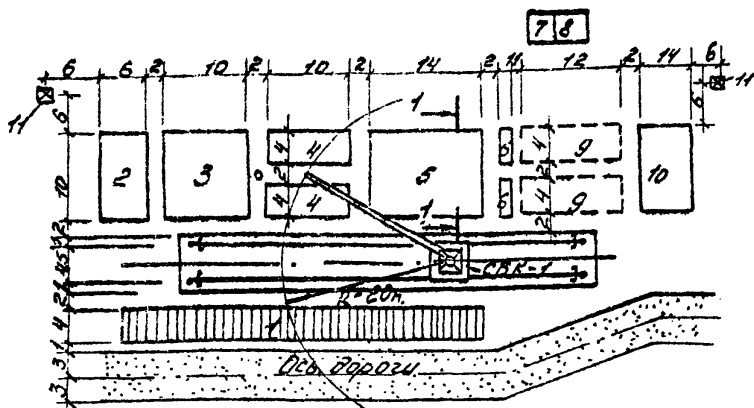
Схема сборно-комплектующей площадки для сборки арматурно-опалубочных блоков. 1 и 10 - склад блоков; 2 - склад щитов и панелей; 3 - место ремонта и смазки панелей; 4 - склады панелей опалубки; 5 - место сборки блоков; 6 - стеллажи; 7 - инструментальная кладовая; 8 - помещение для электросварочных аппаратов; 9 - склад арматуры; 11 - осветительная вышка.
